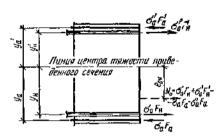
Схема усилий предварительного напряжения арматуры в поперечном сечении железобетонного элемента
